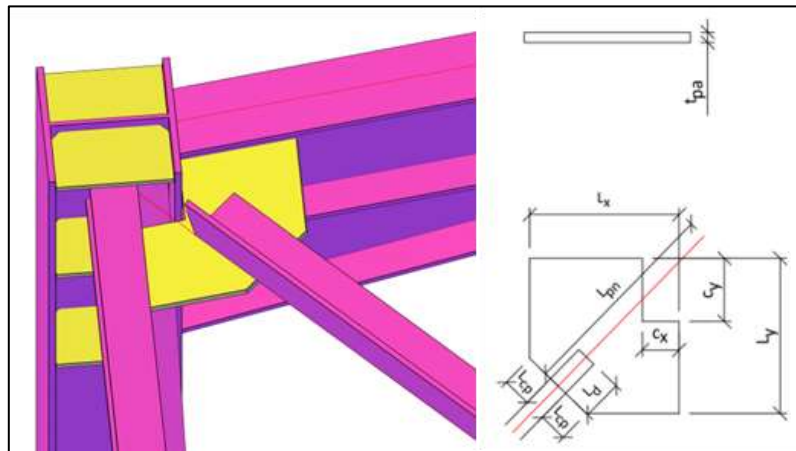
Conexión a corte Arriostre – Techo (Perfiles: alma llena)
